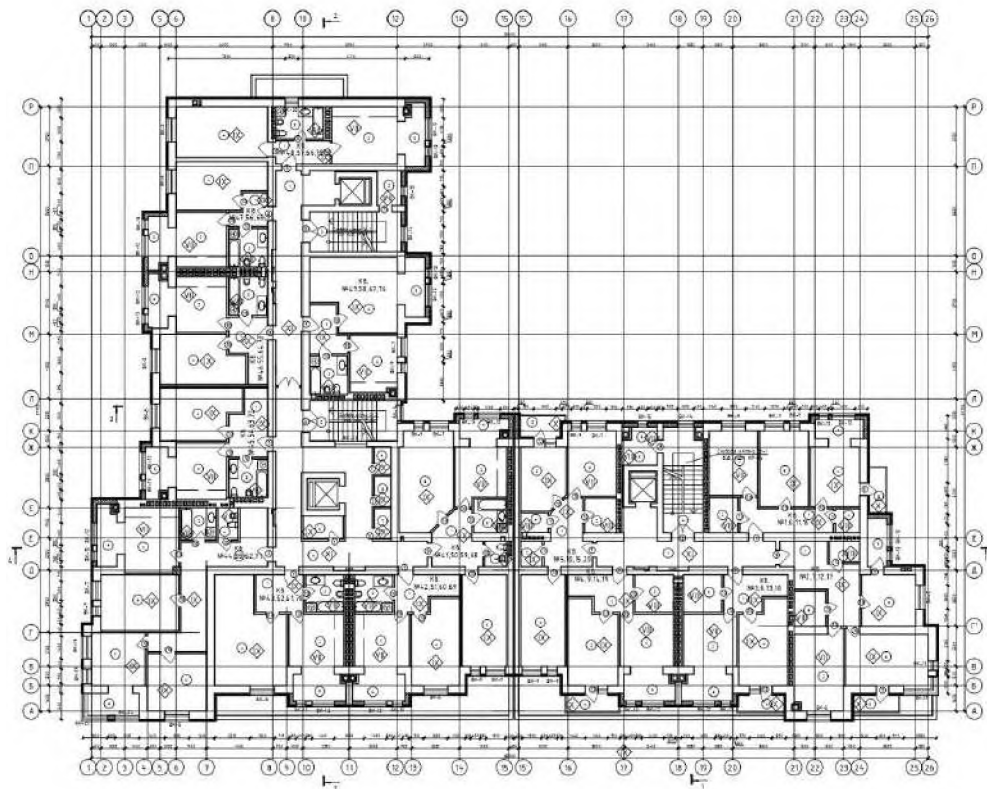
План 3–9 поверхи (на відмітці +6.600...+24.900)
